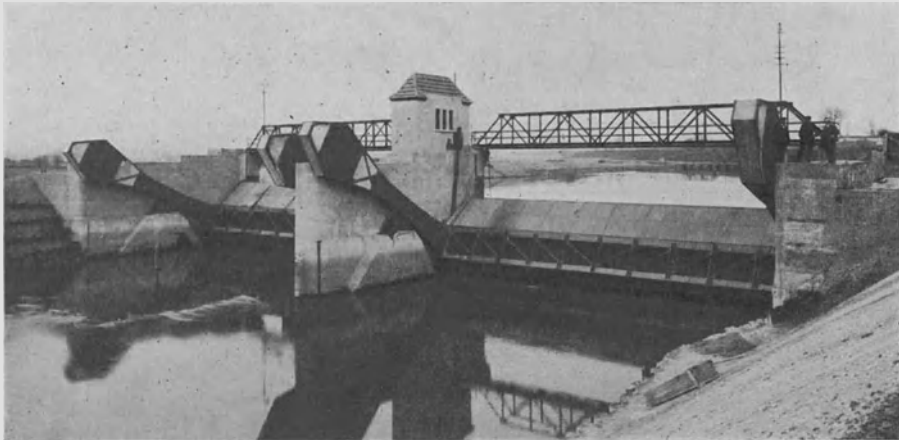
Segmentwehr nach dem System Louis Eilers, Hannover, bei 22 m Lichtweite, 6 m Höchststau; einseitiger Antrieb.
